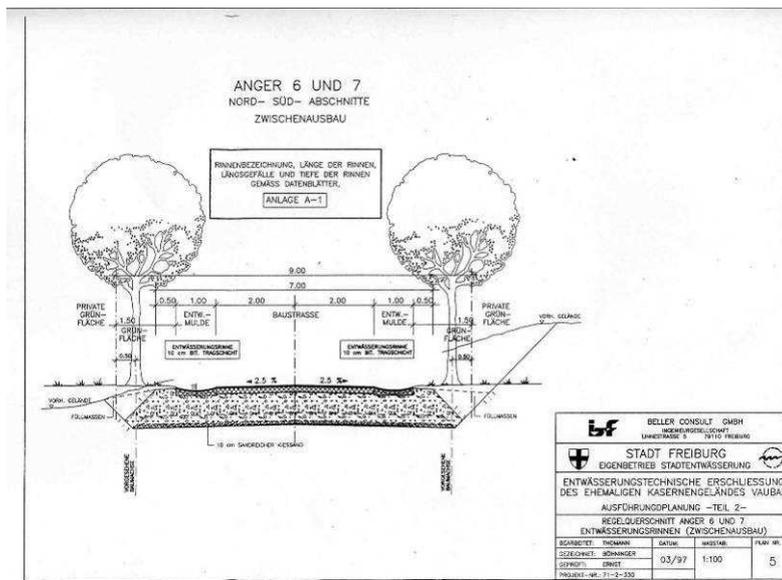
Coupe de la rue latérale avec caniveaux d'eau de pluie.
